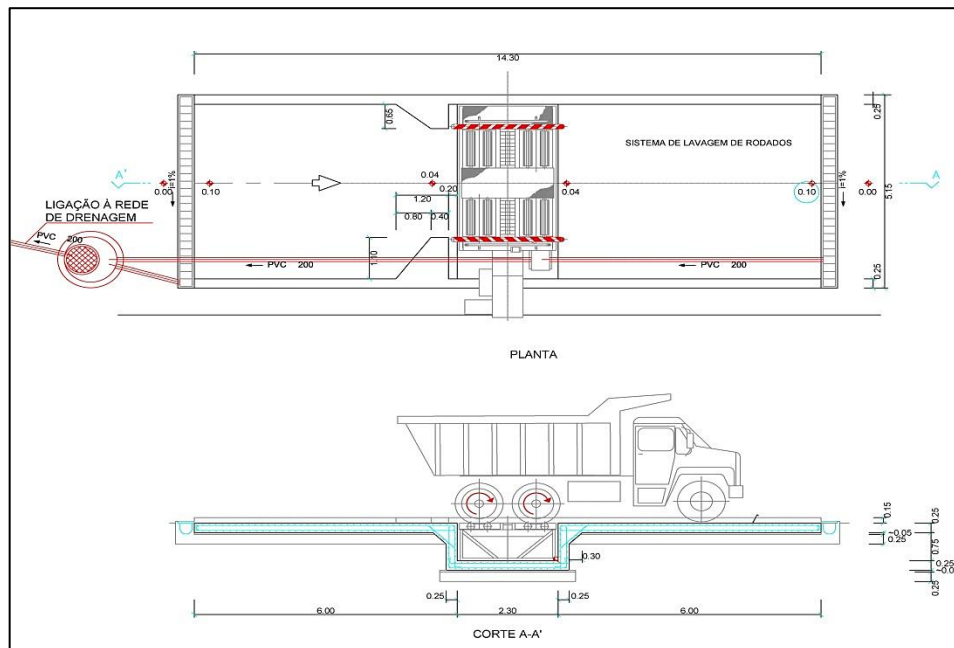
LAVA RODAS (PLANTA E CORTE), (ADAPTADO VALOR AMBIENTE, (2010)).
